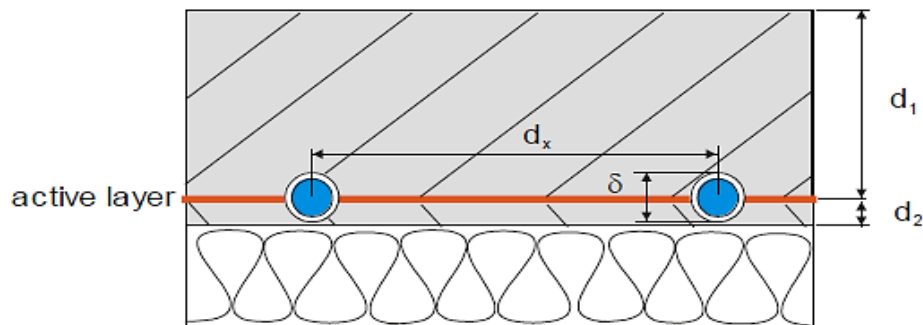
Coupe longitudinale d'un plancher chauffant (U.W, 2010)
